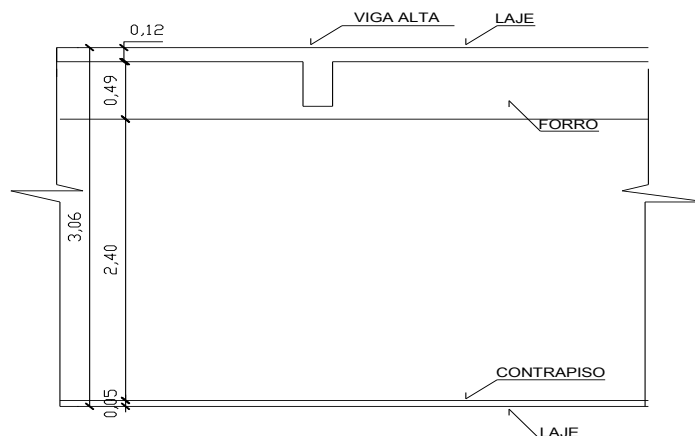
Estrutura Convencional com Laje Maciça. (unidades em metro)
